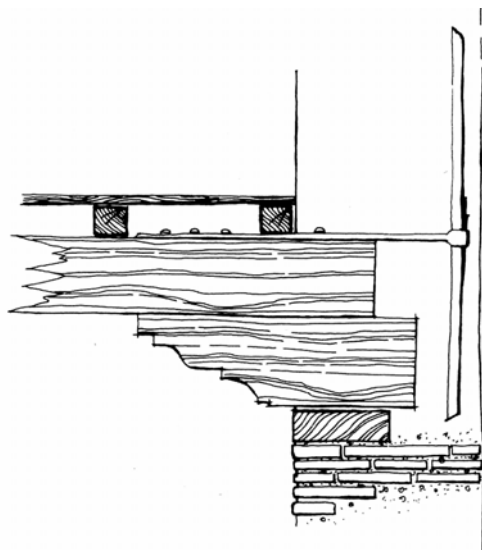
Collegamento della trave maestra al muro con capochiave esterno.
